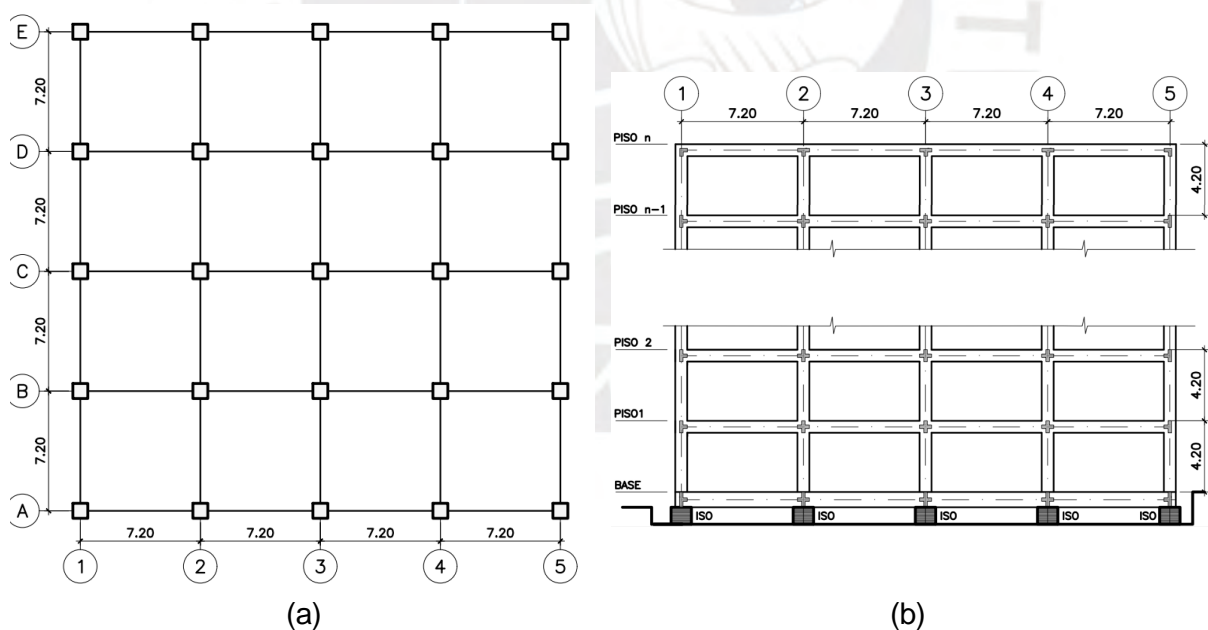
(a) Planta Típica, (b) Elevación de Pórtico Eje 1
